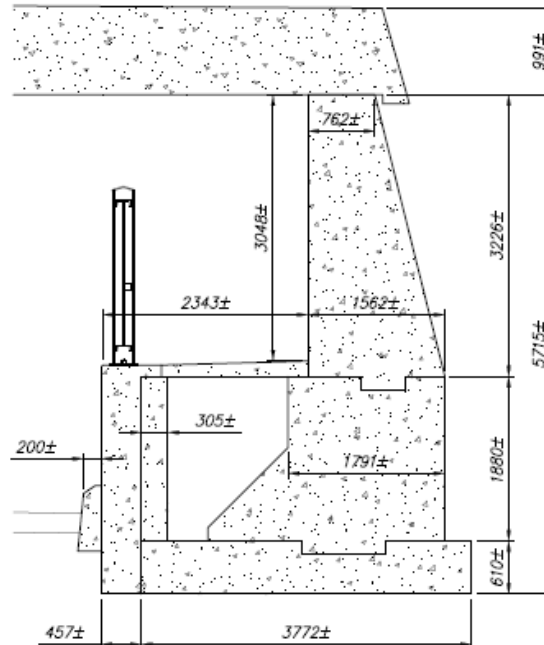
Pont ferroviaire P.F. 81-5170B – Coupe type culée et trottoir structural
